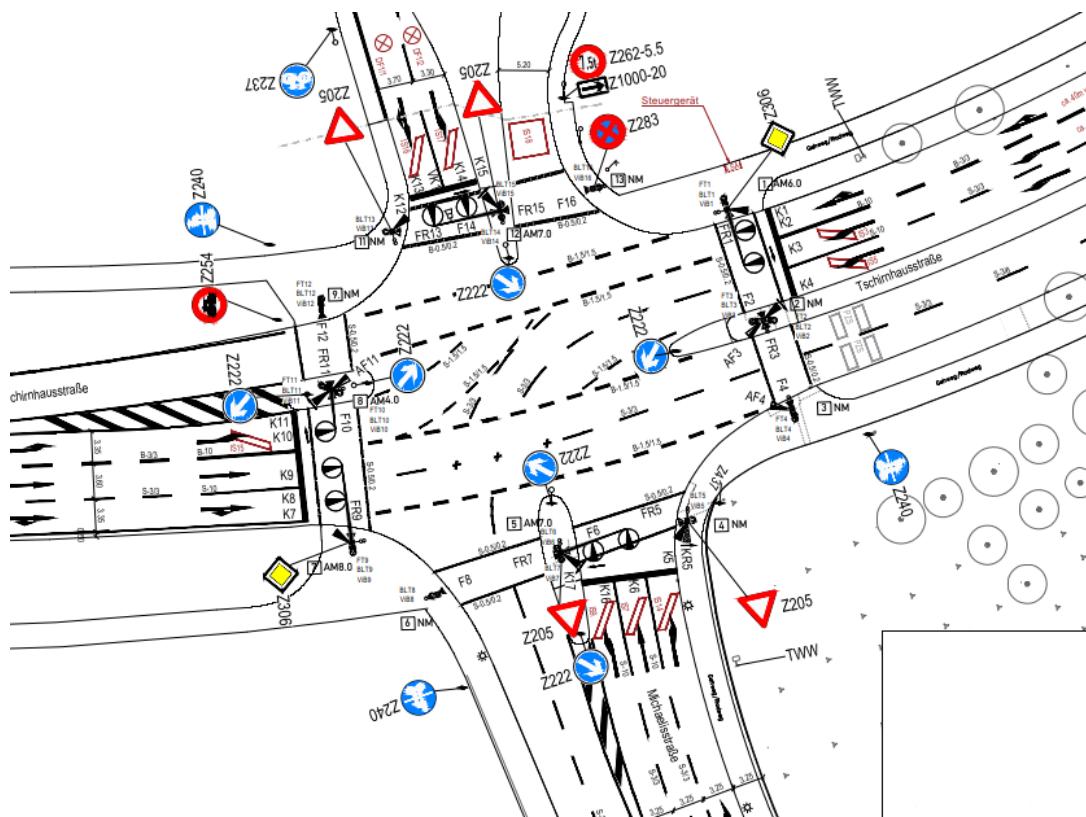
Signallageplan KP1–Tschirnhausstraße / Michaelisstraße – Zufahrt Baumarkt
